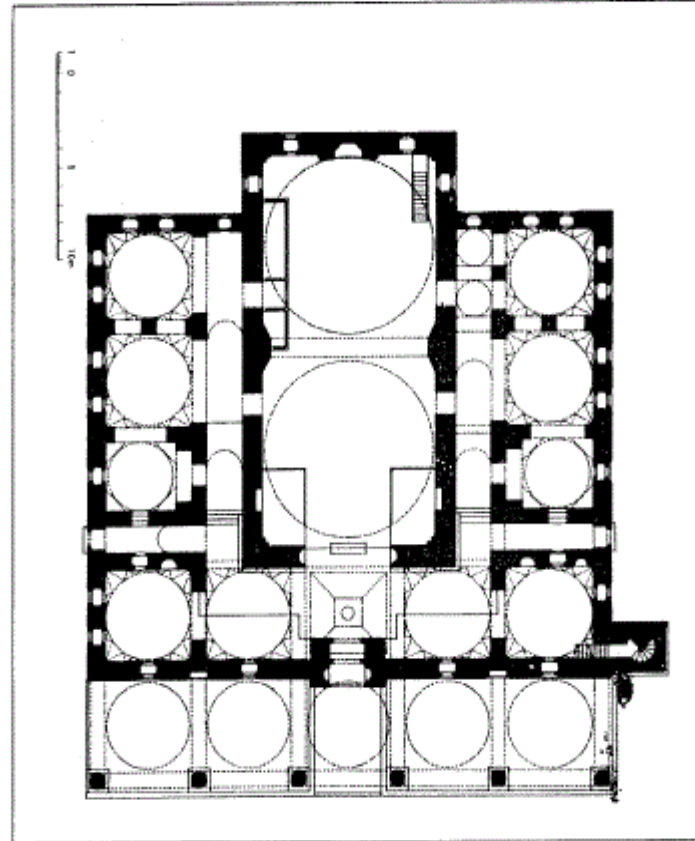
مسقط أفقي لمسجد شهاب الدين باشا في قلاية (عن: أصلان أبا)
